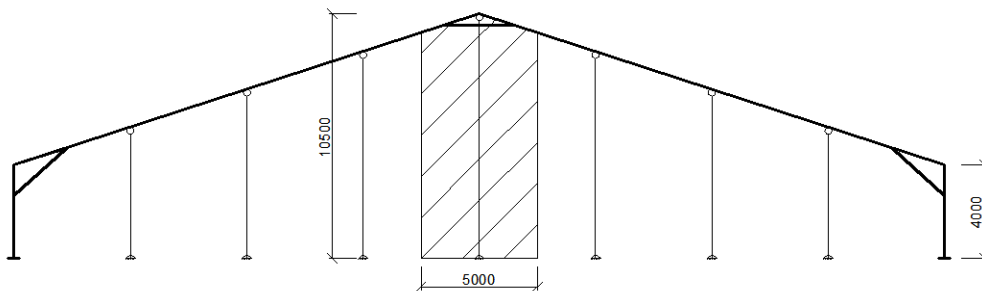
Área de influência para o contraventamento do plano do telhado
